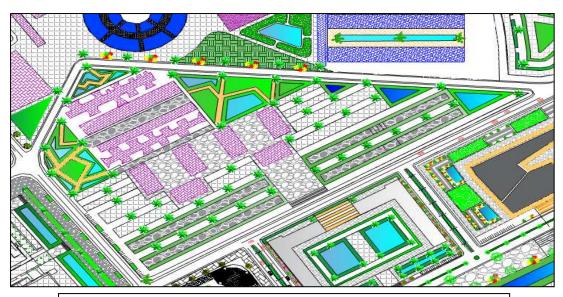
Vue en plan de la placette d'université Source : les auteures
